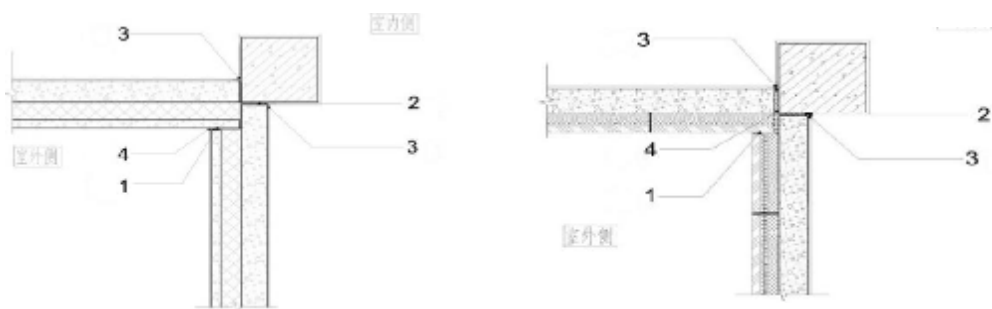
保温装饰复合预制混凝土外挂墙板系统阴角做法示意图
